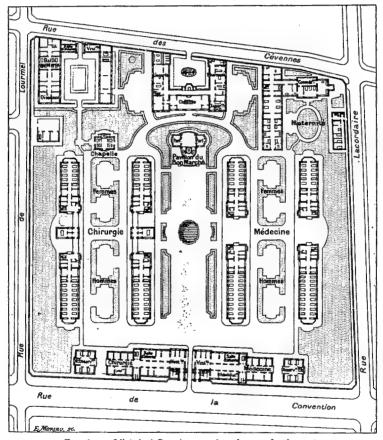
L'hôpital Boucicaut; plan du rez-de-chaussée.
